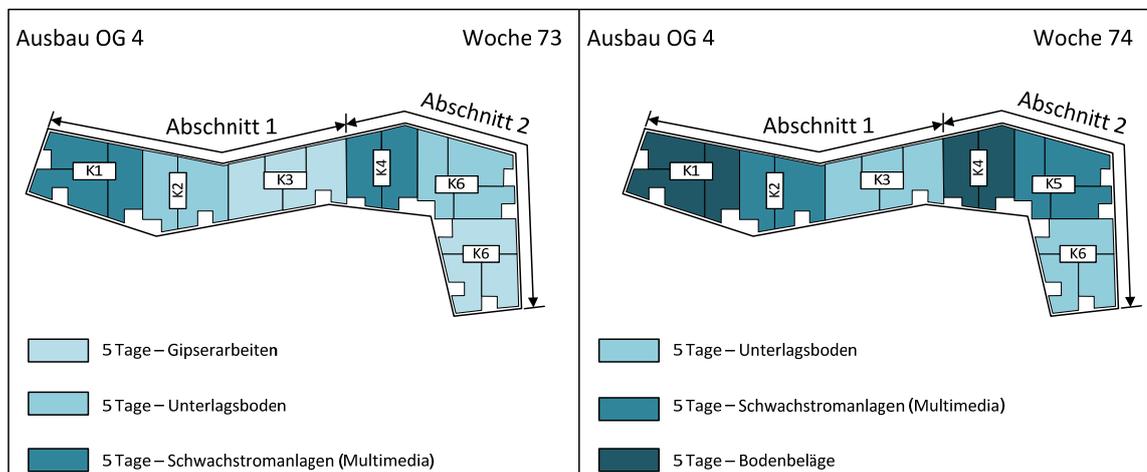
Job-Flächenpläne – Ausschnitt aus dem Flächenmodell einer Hochbaustelle
